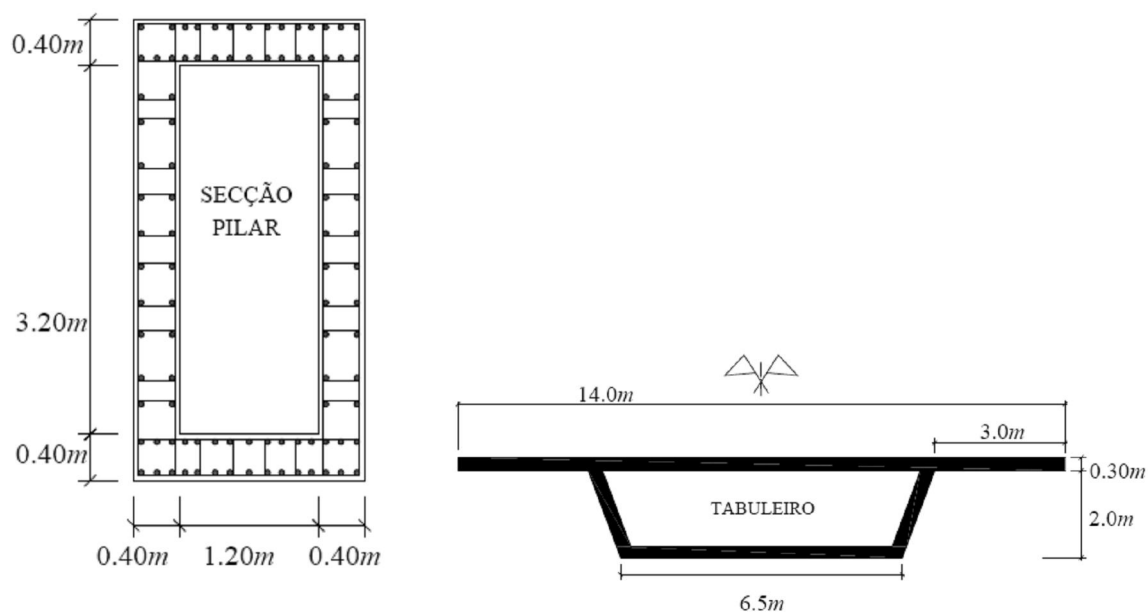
Secção transversal dos pilares e do tabuleiro.
